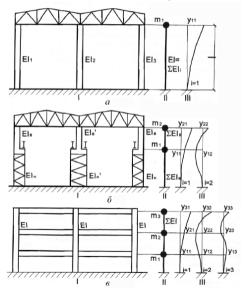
Схемы к динамическому расчету рам каркасов: а, б – одноэтажных промышленных зданий; в – многоэтажного здания; I –
